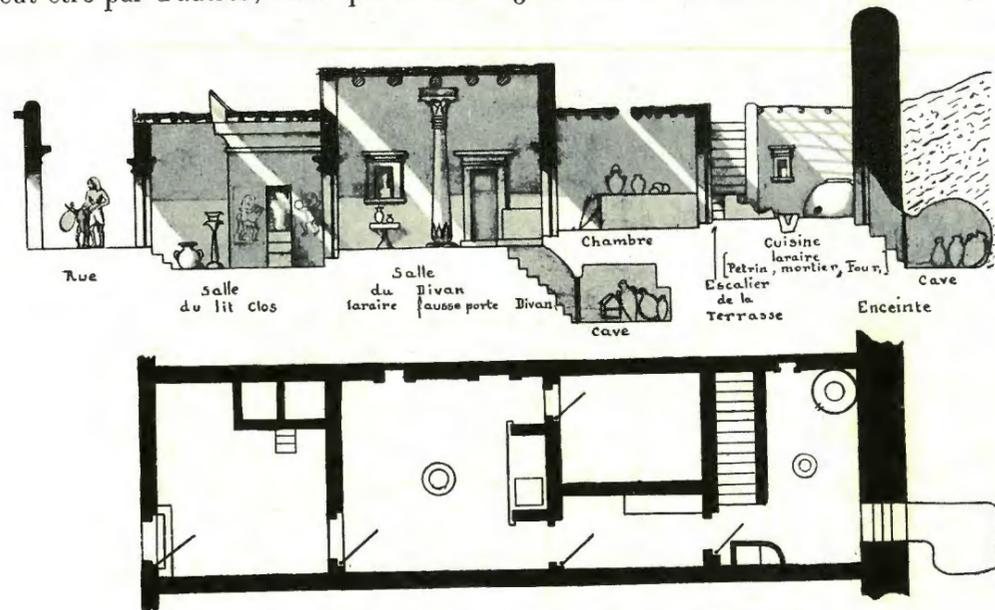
COUPE LONGITUDINALE ET PLAN THÉORIQUE DE LA MAISON TYPE DE DEIR EL MÉDINEH DANS LE VILLAGE CLOS.
